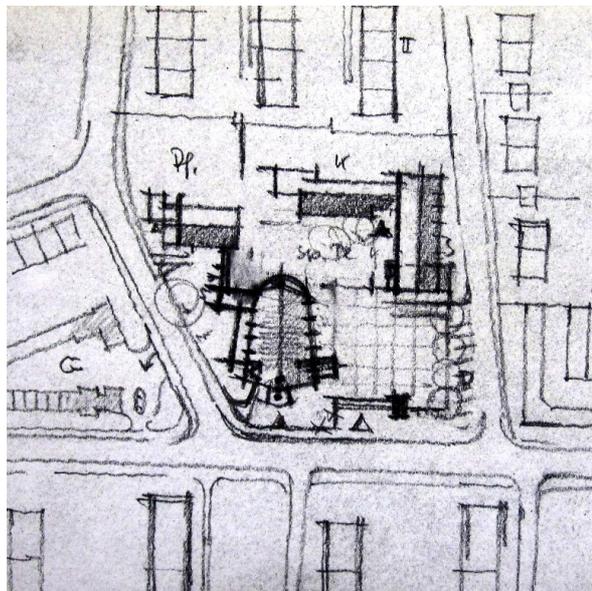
Vorentwurf für den Neubau. Plan B, Lageplan (Ausschnitt), O. Hodler, undatiert
